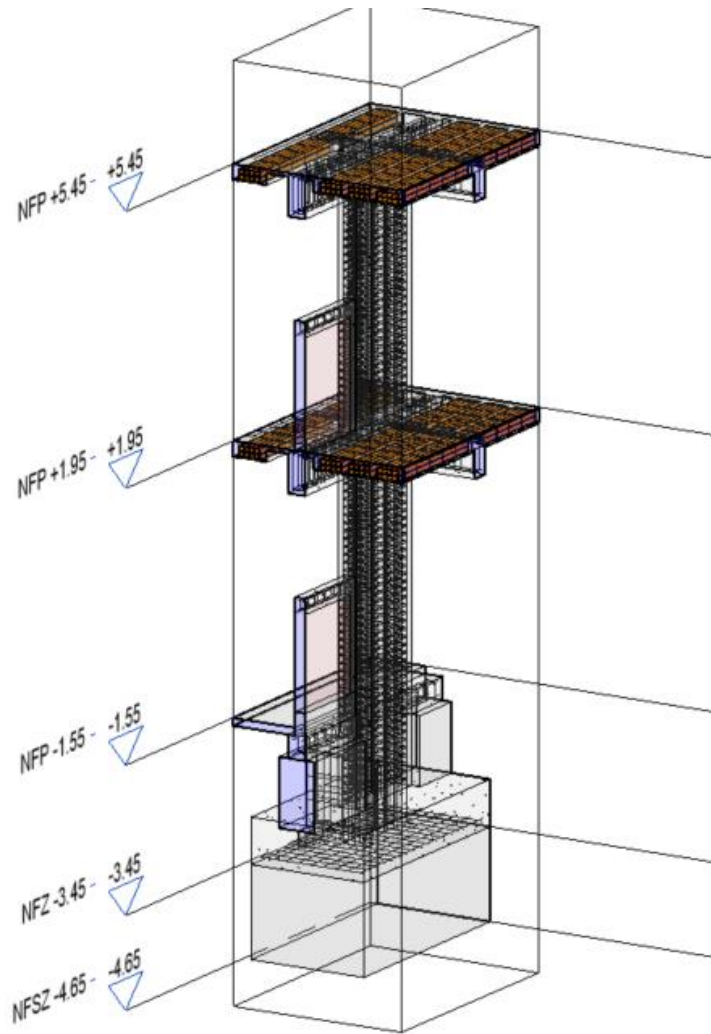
Desarrollo de acero de una columna incluida su cimentación.
